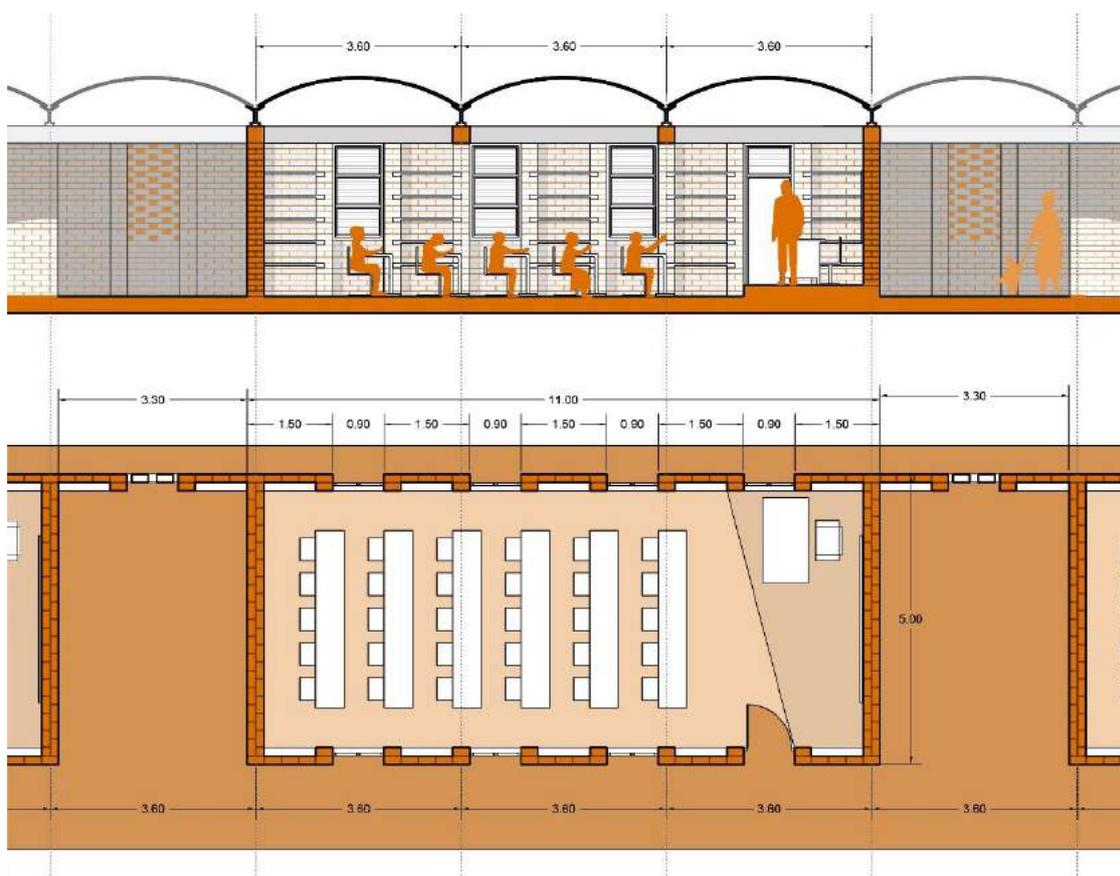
Planta y sección de un aula. Fuente: Elaboración propia
